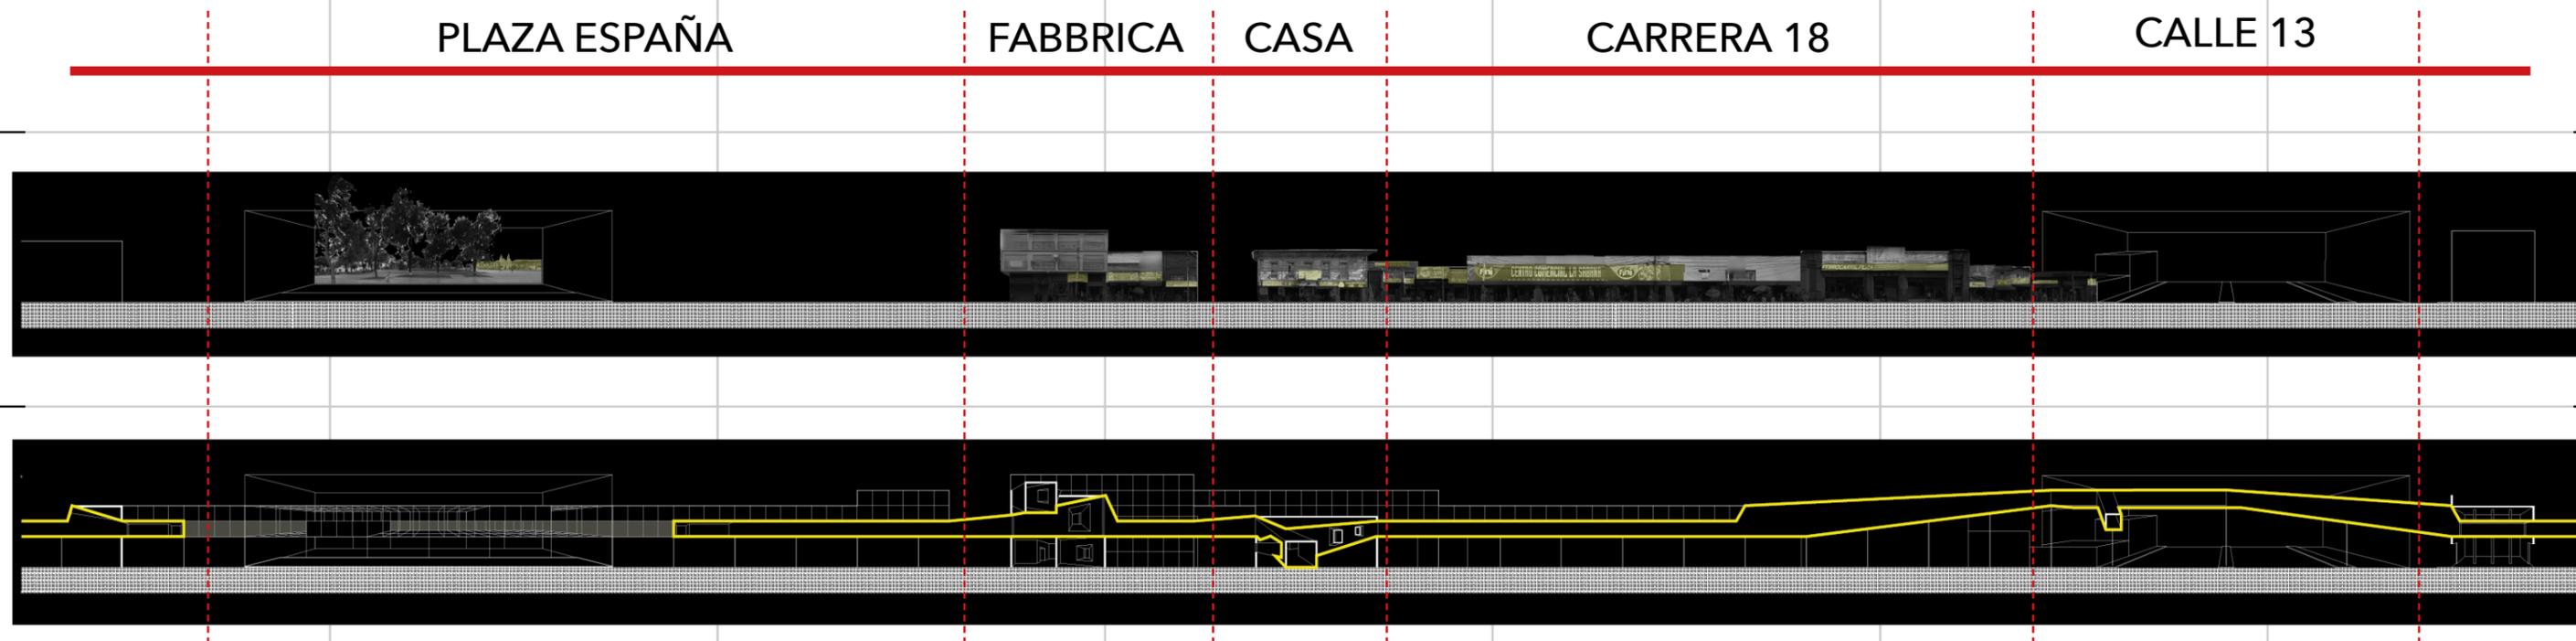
, prospetto e sezione degli spazi probabili lungo la carrera 18
